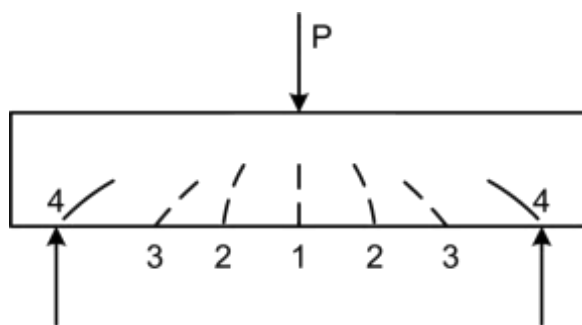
Образование трещин в бетонных балках [1].
